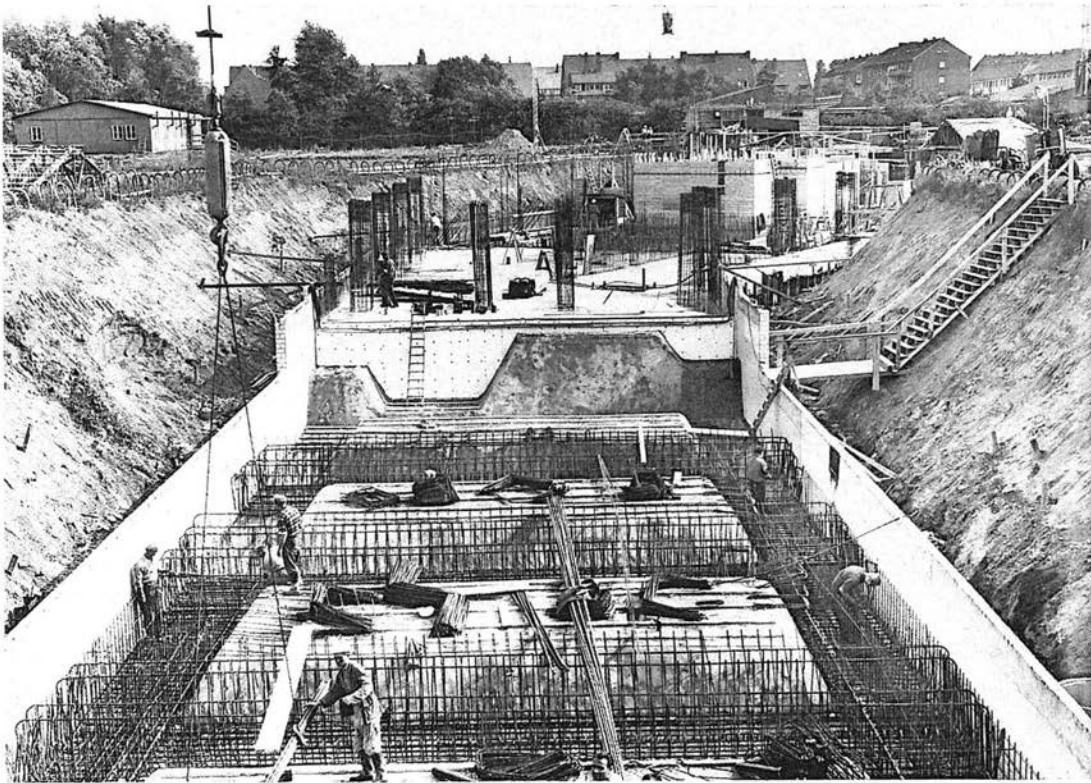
Bewehrungsarbeiten an Fundamenten und im Kellergeschoß
